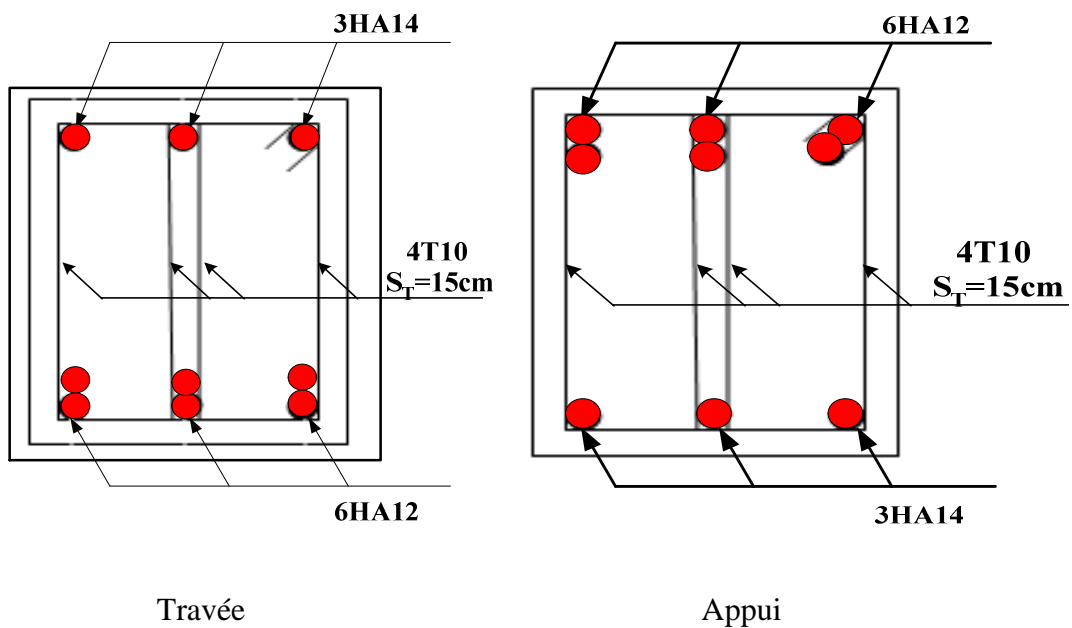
Schéma de ferrailage des poutres principales de la terrasse
